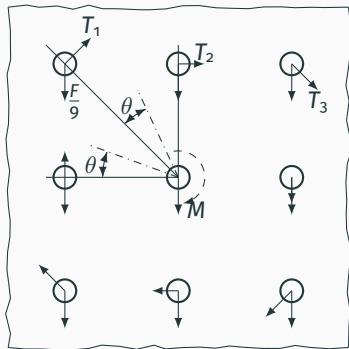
Ligação com pré-esforço e carregamento excêntrico no plano da ligação [2].
